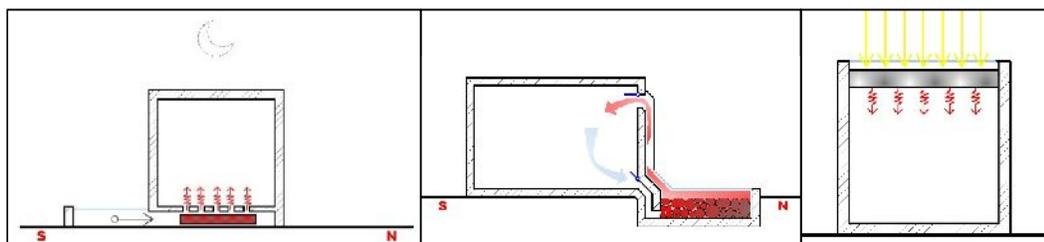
Sistema plano horizontal. Fuente: Barrera C.
